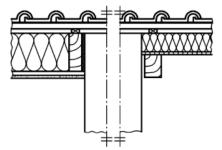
Schemaschnitt Einbindung von Innenwänden in Dachkonstruktion und Außenwand nach DIN 4109-33 [6]
